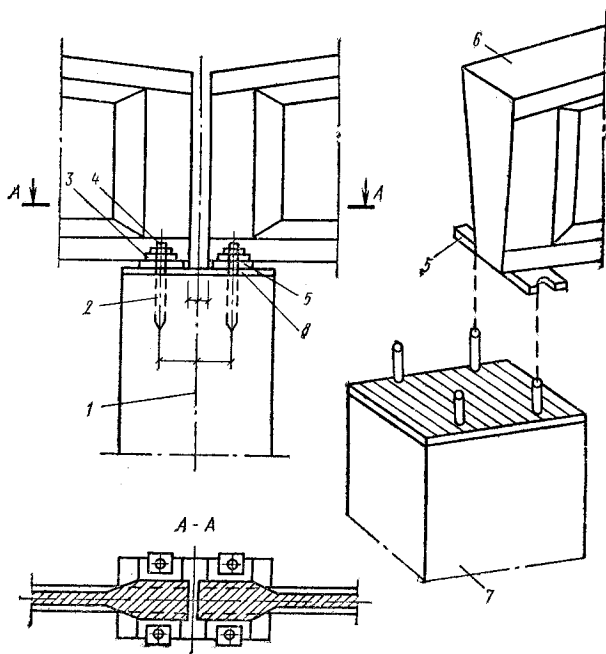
Соединение ригеля с колонной на анкерных болтах и монтажной сварке
